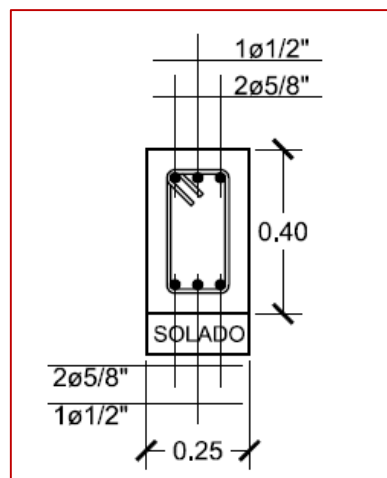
Disposición de Acero Longitudinal de la Viga de Cimentación Ubicada en el Eje "1", Tramo "A" y "C" del Módulo: Aulas
